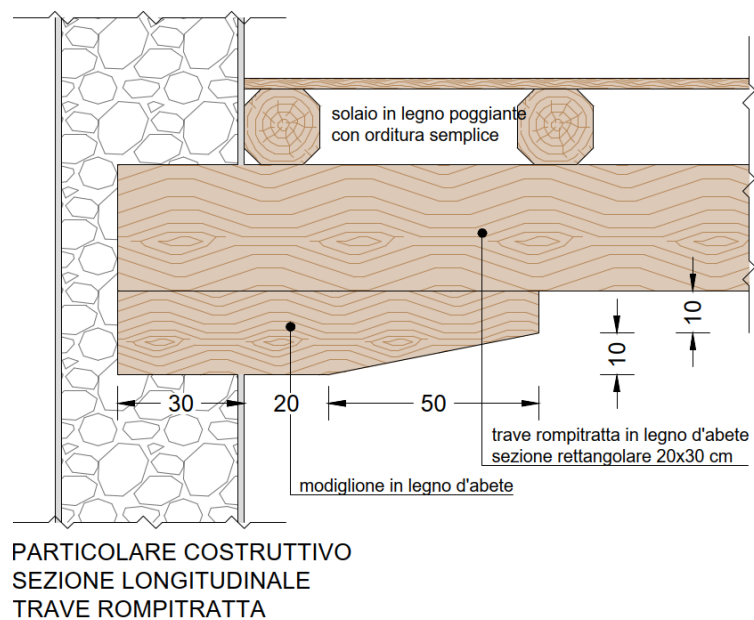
Particolare costruttivo Trave rompitratta - Sezione longitudinale
